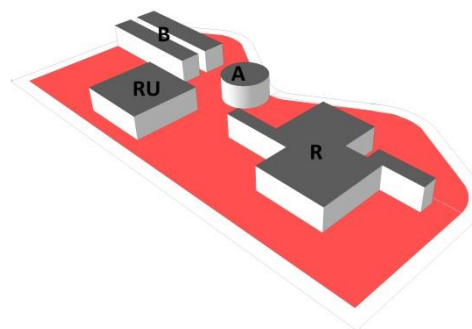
Praça Cívica Plano Piloto 1977. Fonte: Mapa Base Prancha 1 – Plano Piloto 1977. Disponível na DOP/PTO. Desenho Renan Avanci.
